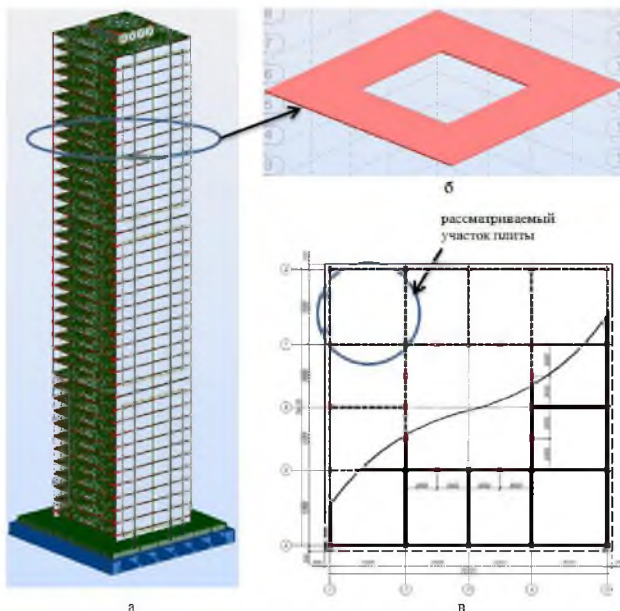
а) расчетная схема высотного здания; б) плита перекрытия; в) план типового этажа с обозначением рассматриваемого участка плиты
